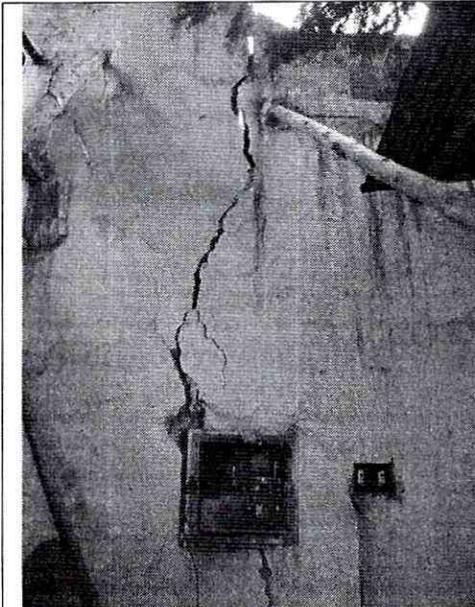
Grietas severas en el muro del costado noroccidental de la construcción visitada.
